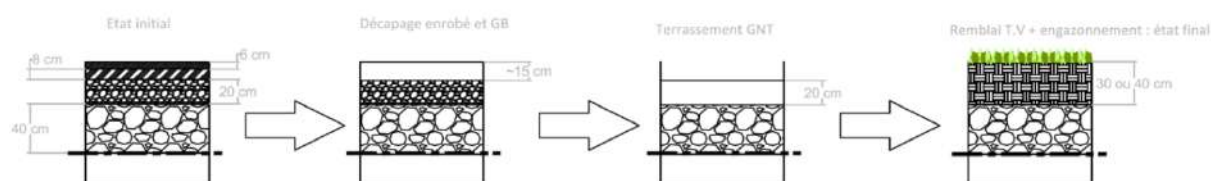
Etape de mise en œuvre d'un espace vert sur une ancienne voirie. Source : Maude Duplan.
